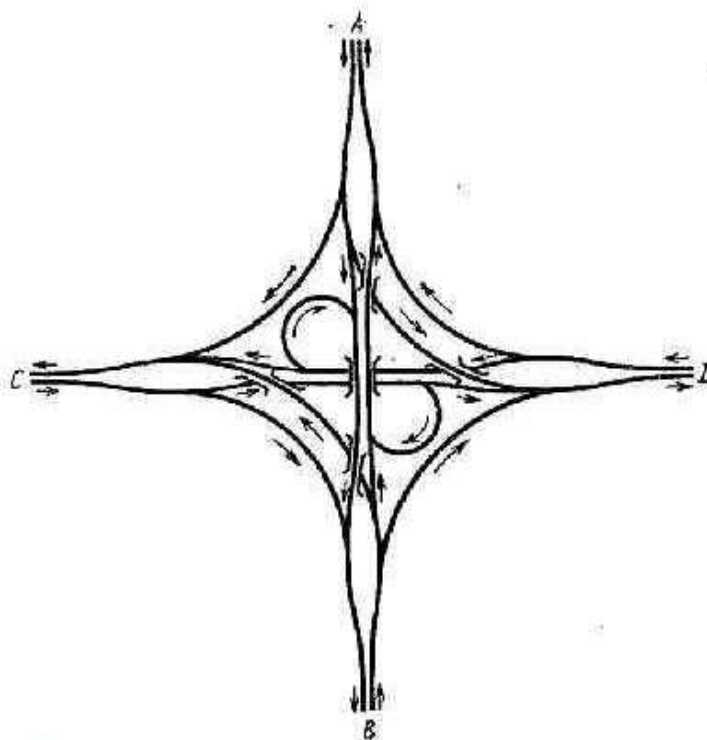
Улучшенная транспортная развязка «клеверный лист» с двумя направленными левоповоротными соединительными ответвлениями
